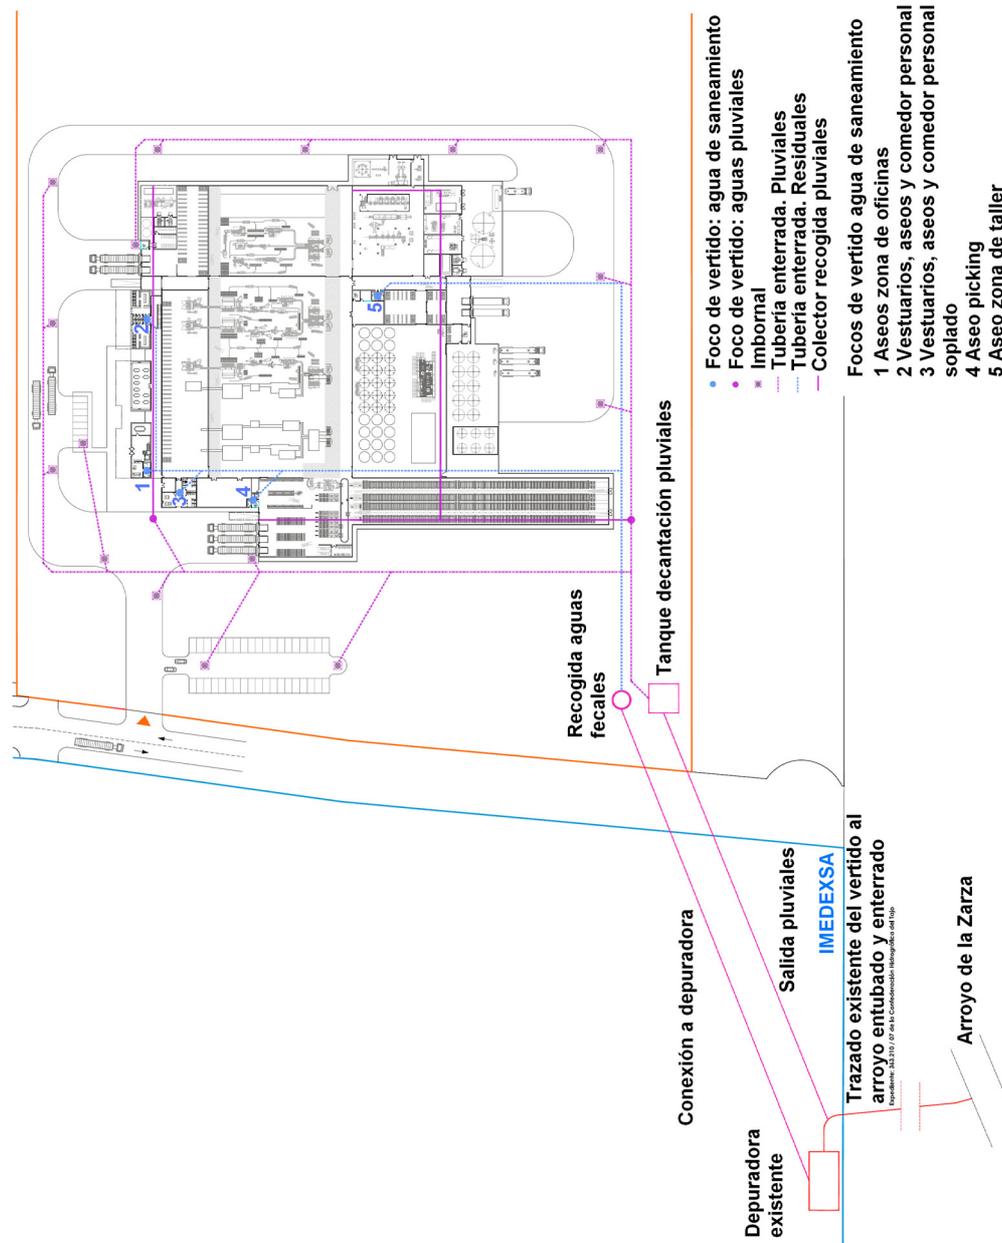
Plano en planta de las instalaciones, con la red de saneamiento de aguas fecales y pluviales
